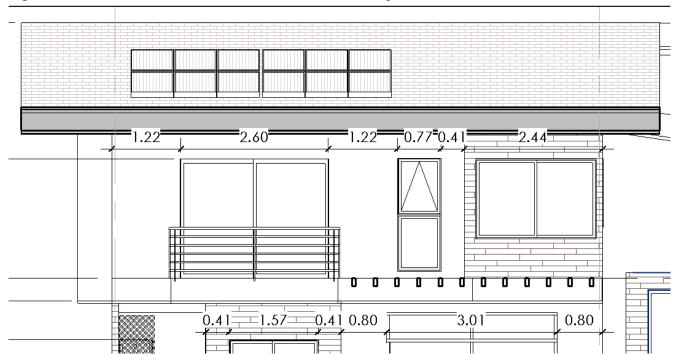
Detalle de la fachada este con modulación de los paños de cerramiento exterior
